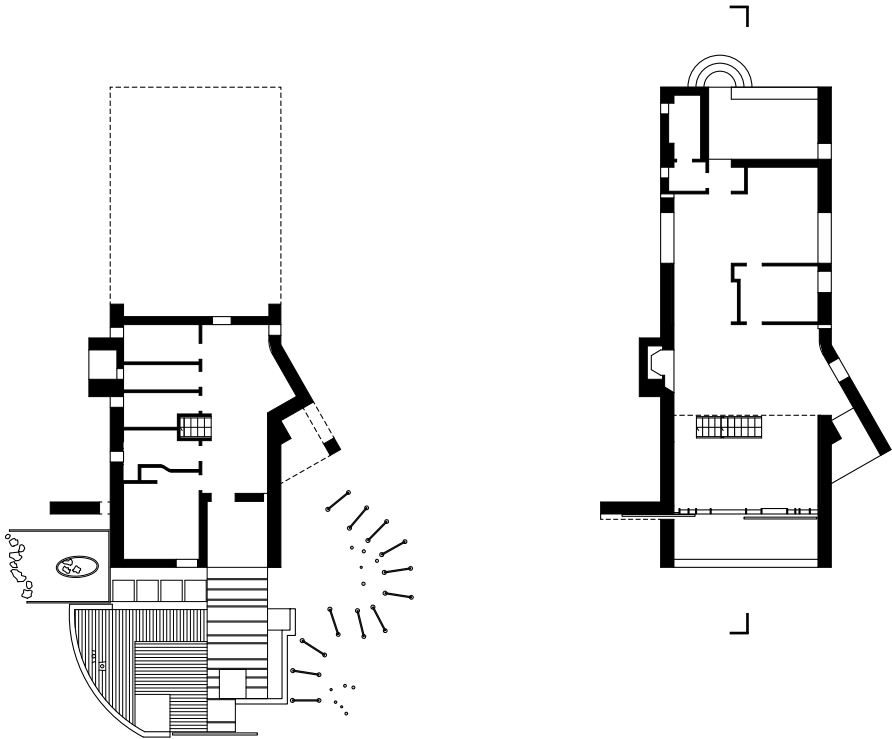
Edificazione del lotto di progetto (evoluzione planimetrica)
